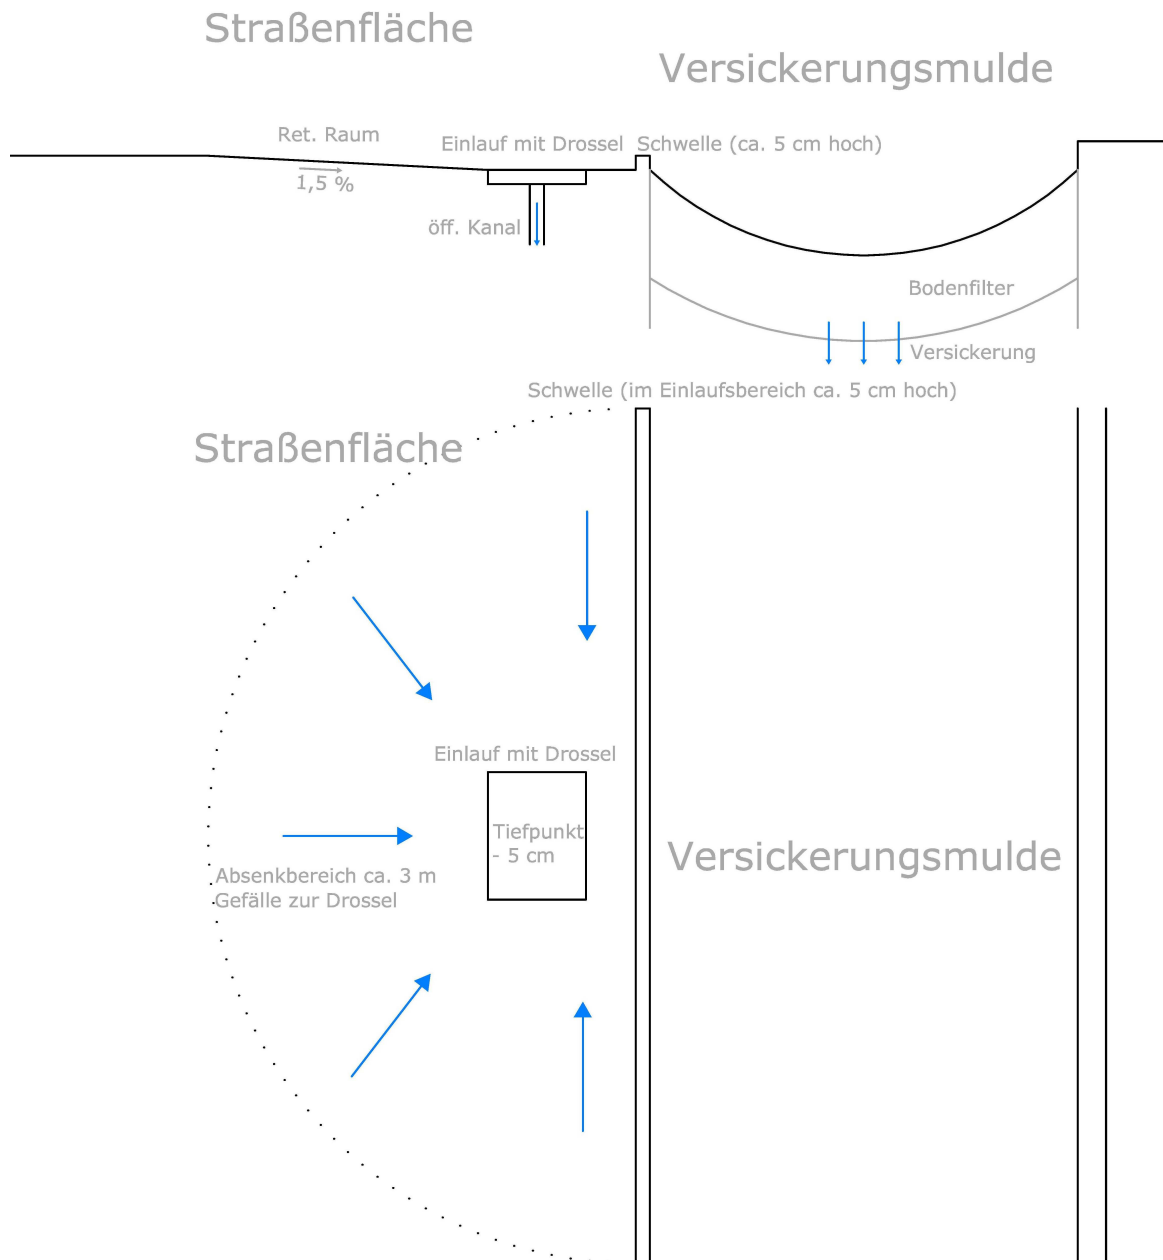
Systemzeichnung Trennung durch Schwelle (Schnitt und Grundriss)
